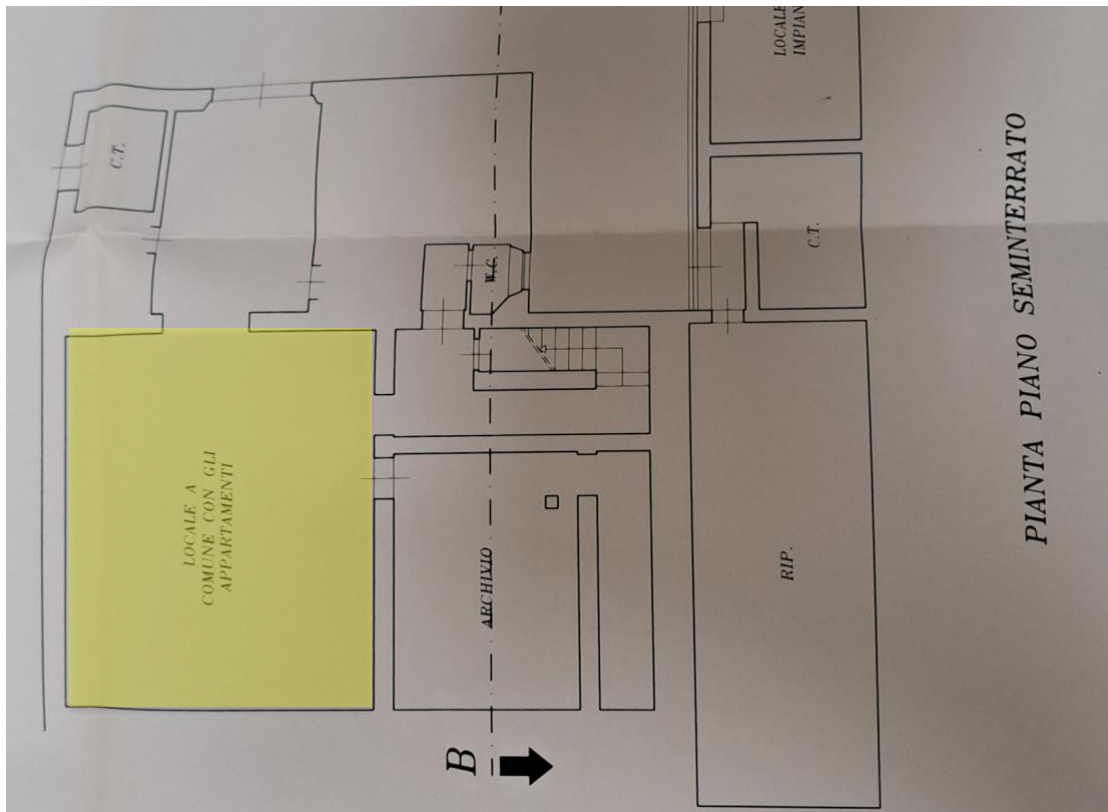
Stato di progetto dell’Aut. Ed. n. 71/1999
